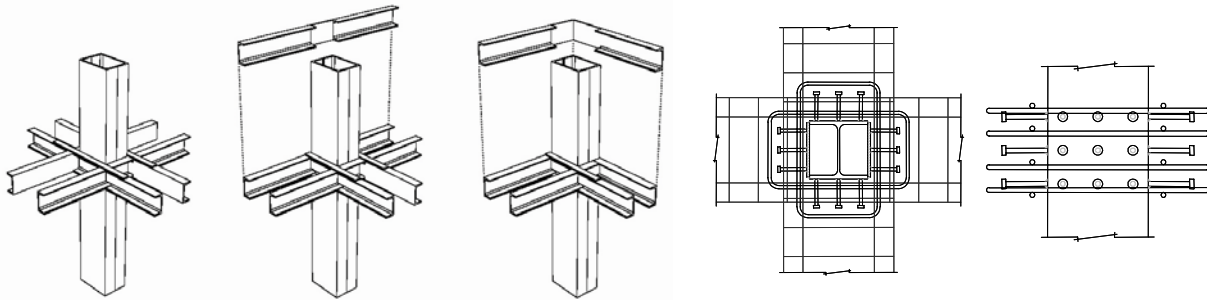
Detalles de conexión de forjados de hormigón a pilares metálicos con crucetas y con pernos conectadores
